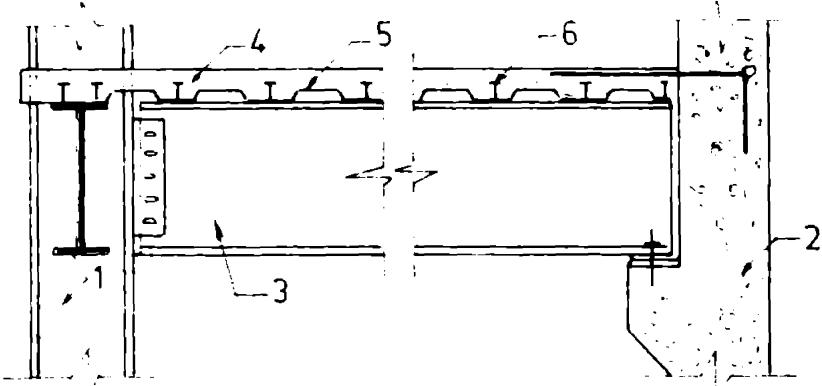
1-Grindă și stîlp oțel, cadru exterior. 2-Diafragmă centrală. 3-Grindă oțel planșeu. 4-Placă beton armat. 5-Cofraj piercut tablă cutată. 6-Elemente de legatură dornuri
